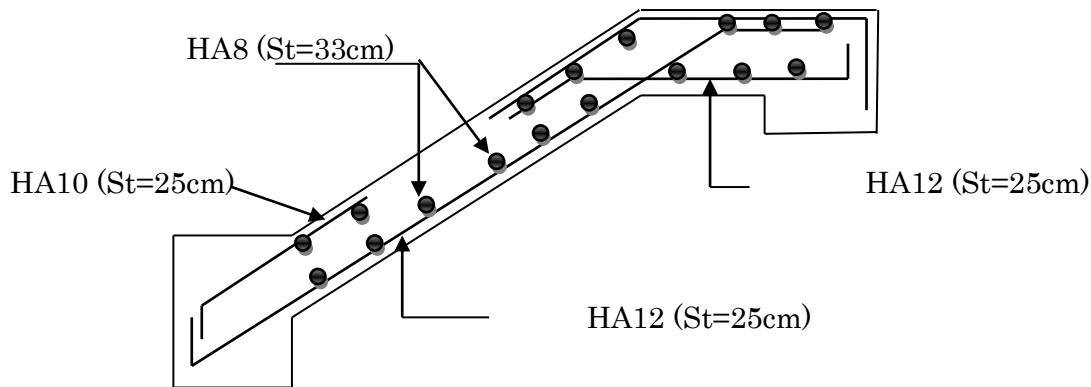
Schéma de ferrailage de l'escalier du type 2
